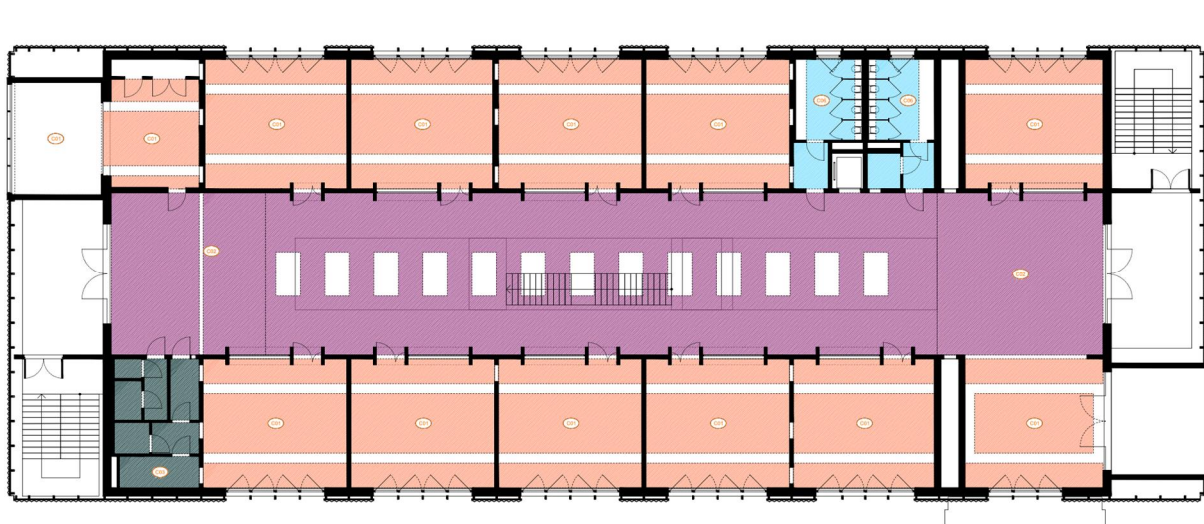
Planimetria del piano secondo con indicazione dei trattamenti acustici da realizzare nel corridoio (controsoffitto fonoassorbente C02)
